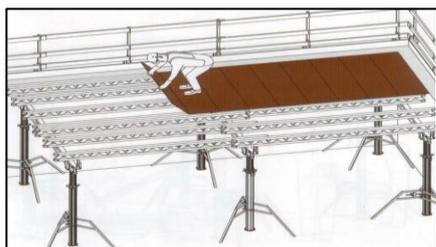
Укладка листов фанеры: 1 - поперечная балка; 2 - укладываемый щит; 3 - уложенный и закрепленный щит; 4 - ограждение по периметру перекрытия
